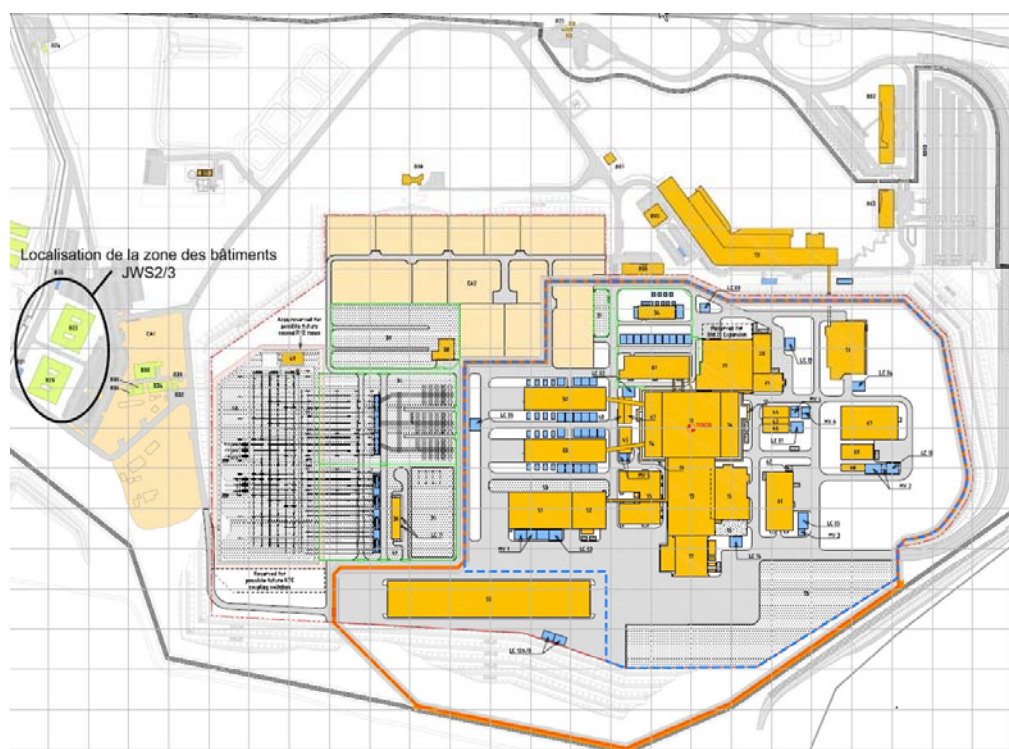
Plan d'implantation de la zone des bâtiments JWS2/3
